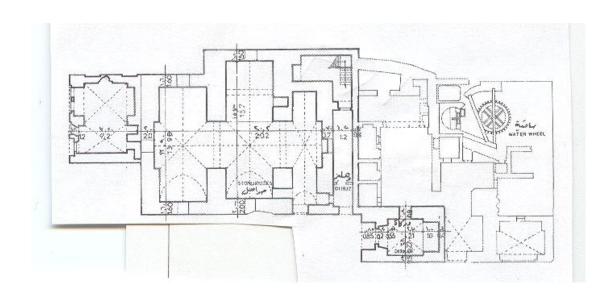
مسقط أفقى لكشك "خضر الياس".
